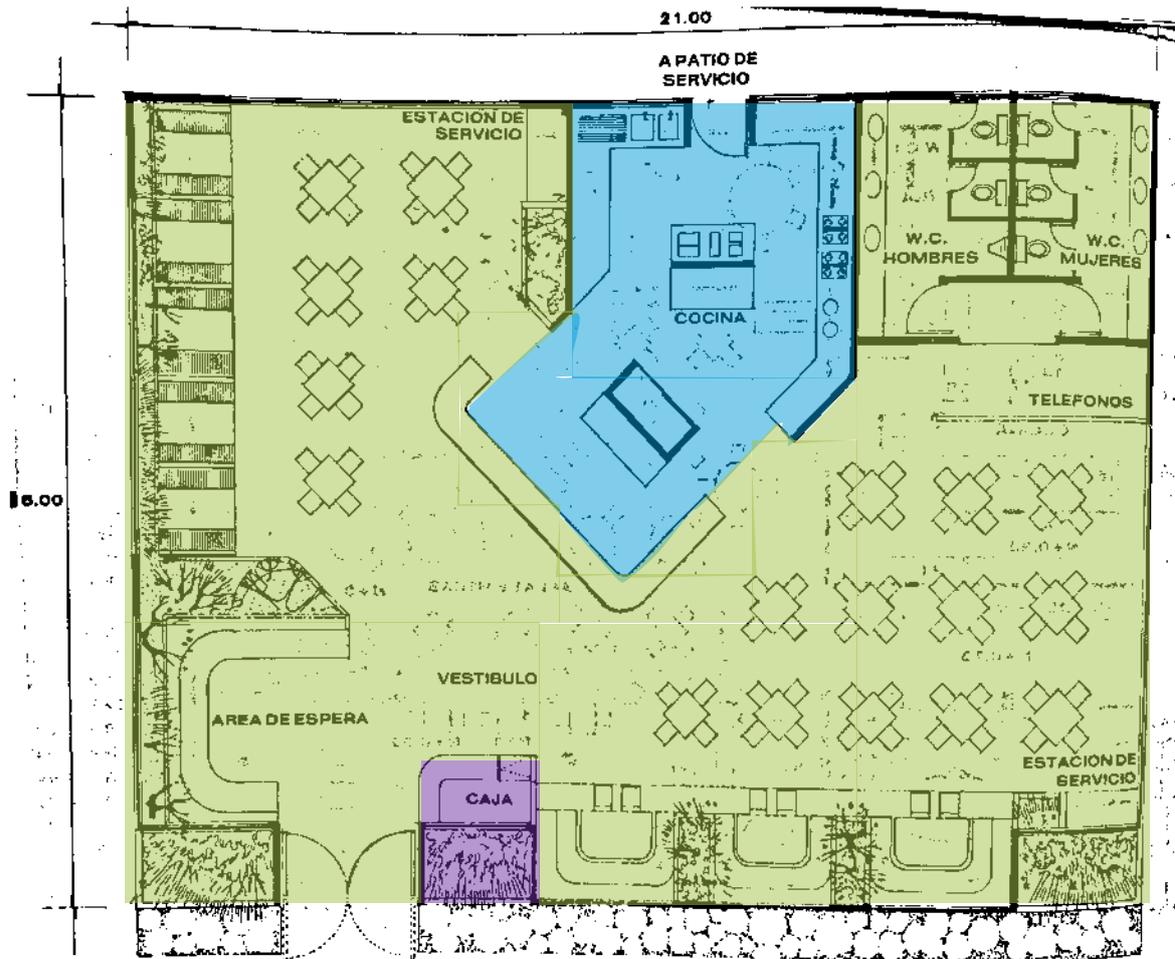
"Planta Arquitectónica de la cafetería general"
